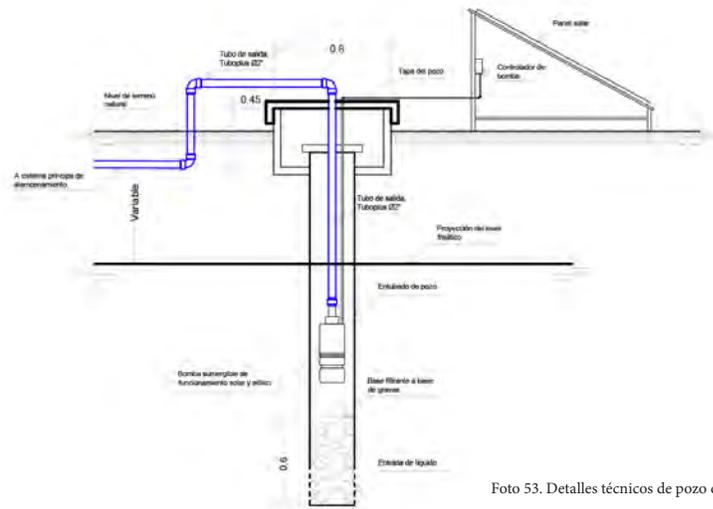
Detalles técnicos de pozo de abstracción. Para mayor detalle ver plano IH-06
